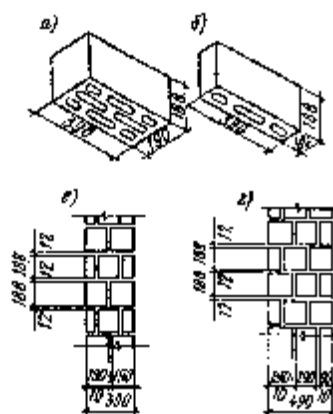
Стена из легкобетонных камней с щелевидными пустотами: А – камень щелевидный; б – продольная половинка; в и г – разрезы стен
